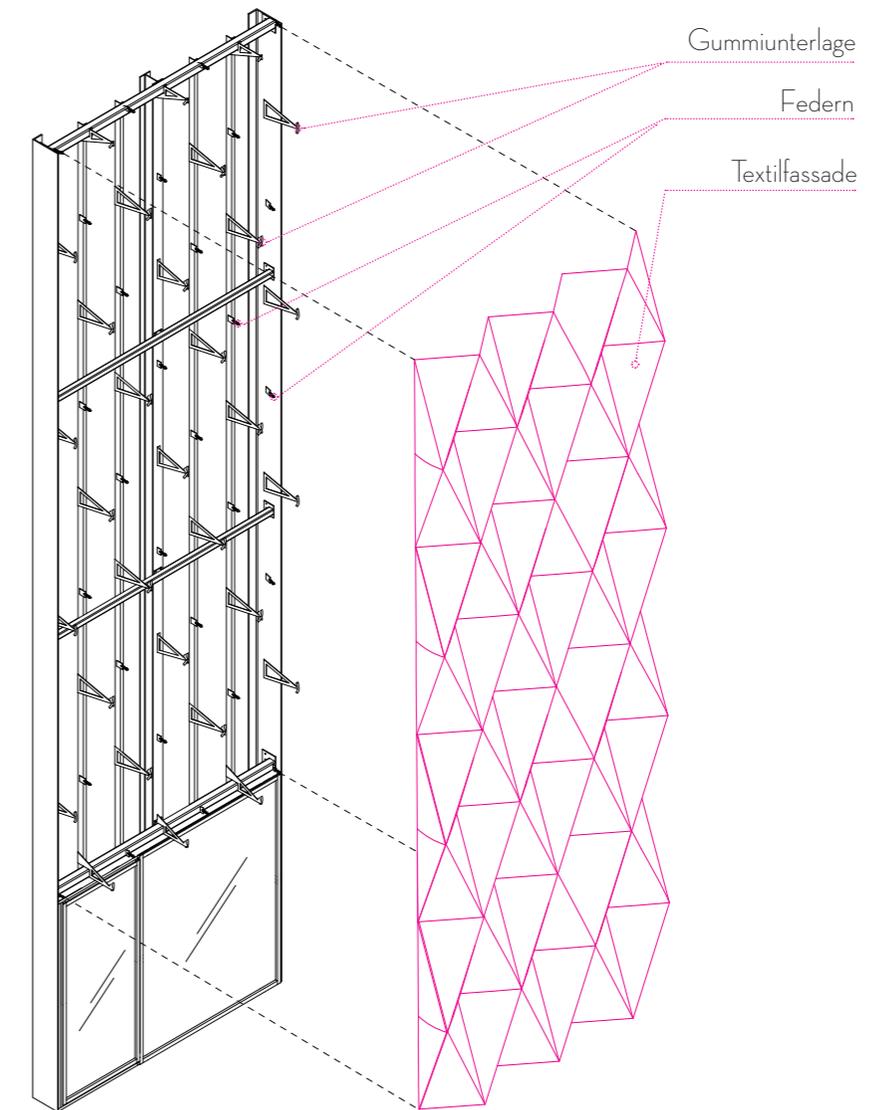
Montagesystem straßenseitig. Erdgeschoß bleibt unverbaut
